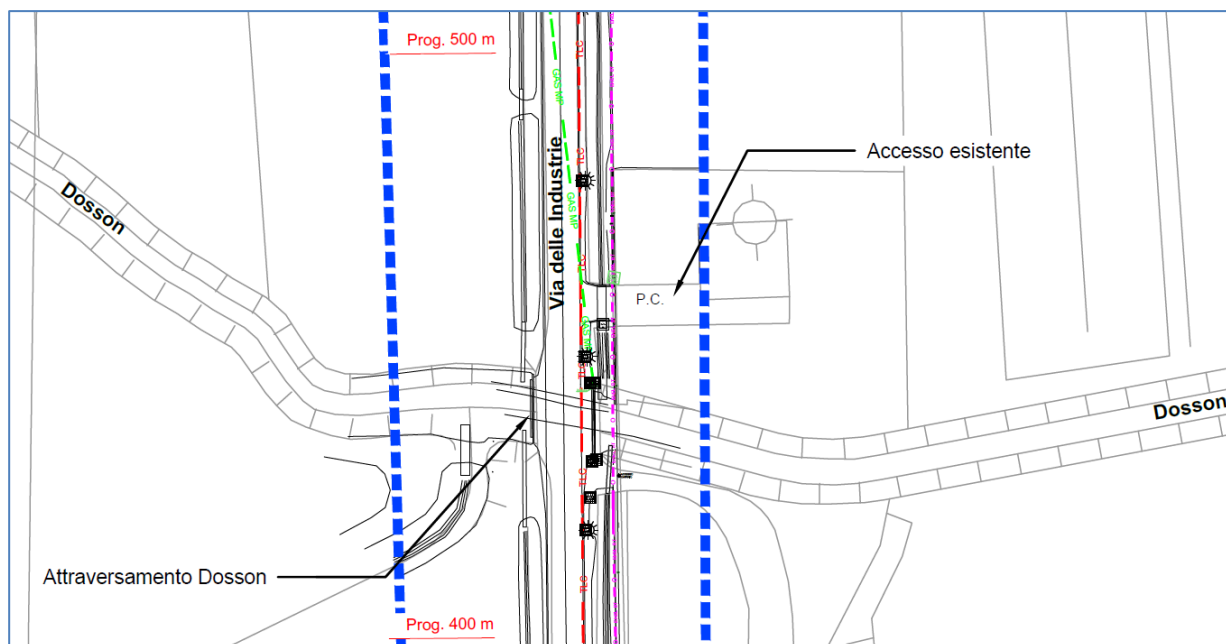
Estratto dalla tavola dei sottoservizi rilevati (attraversamento Scolo Dosson).
